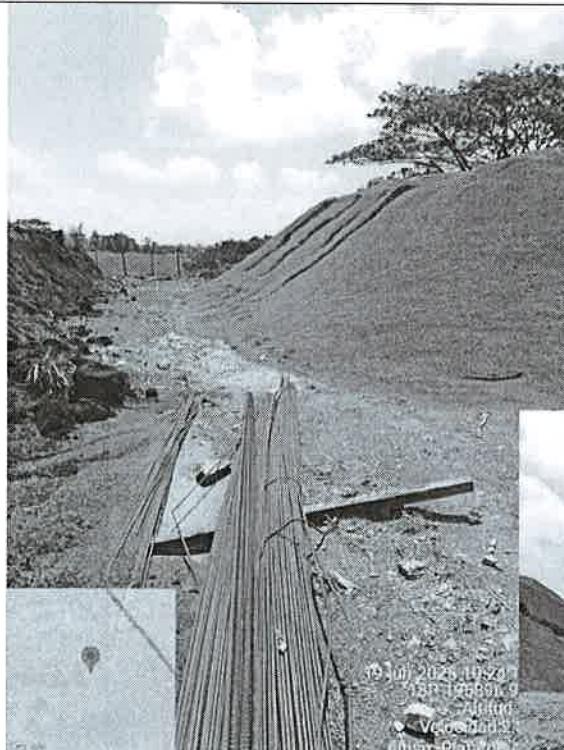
Área de la entrada del proyecto de la planta de asfalto temporal, ya cuenta con material.
